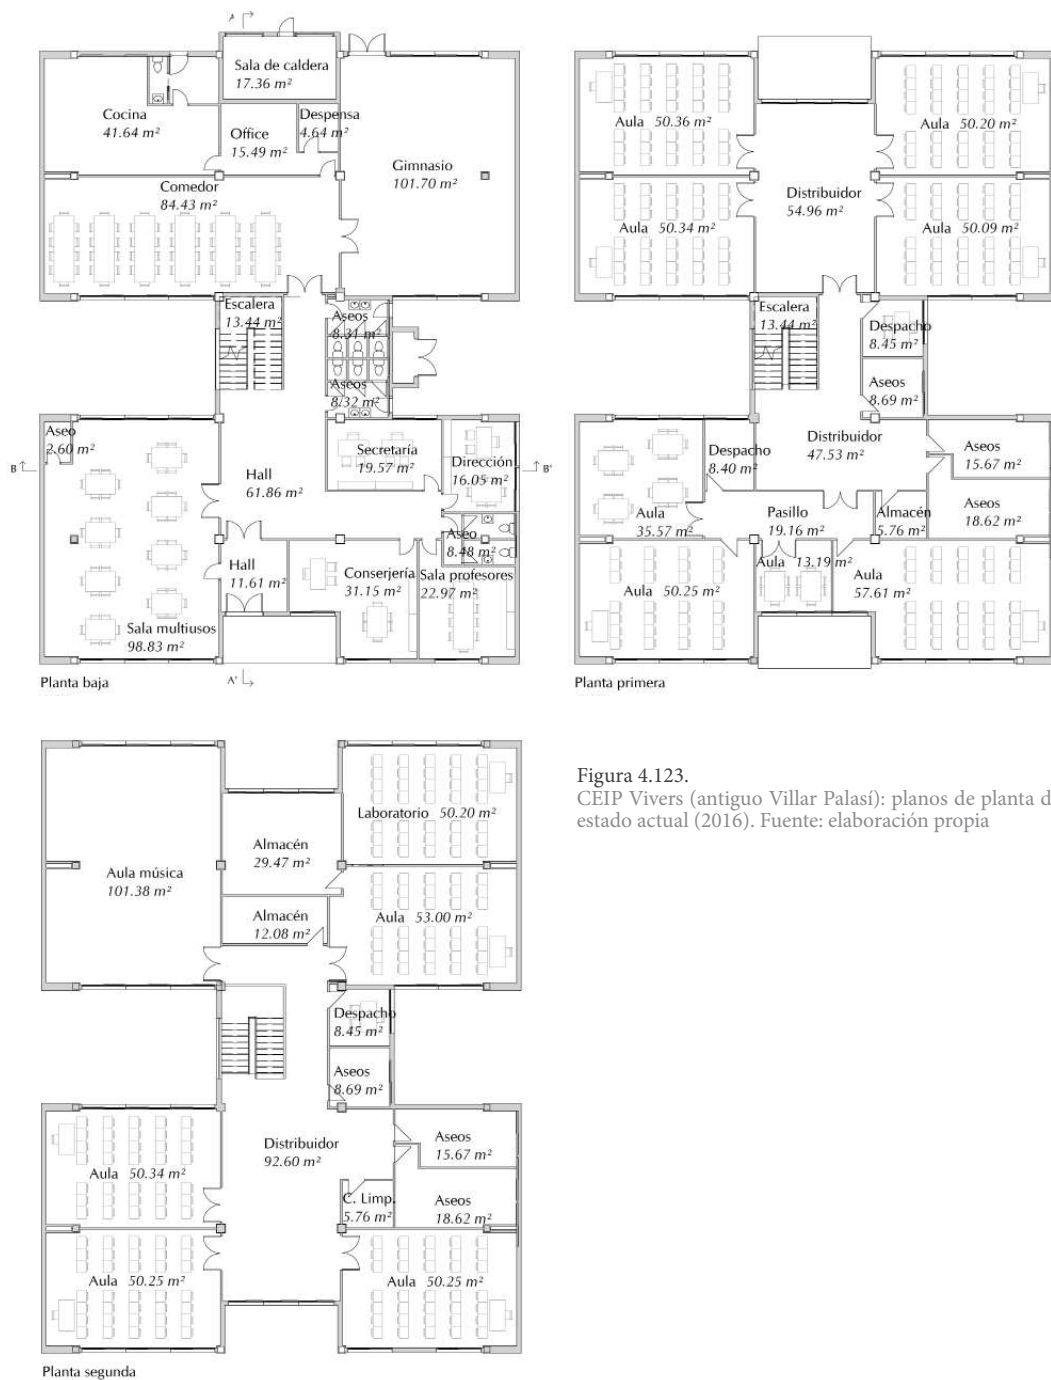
CEIP Vivers (antiguo Villar Palasí): planos de planta del estado actual (2016). Fuente: elaboración propia
